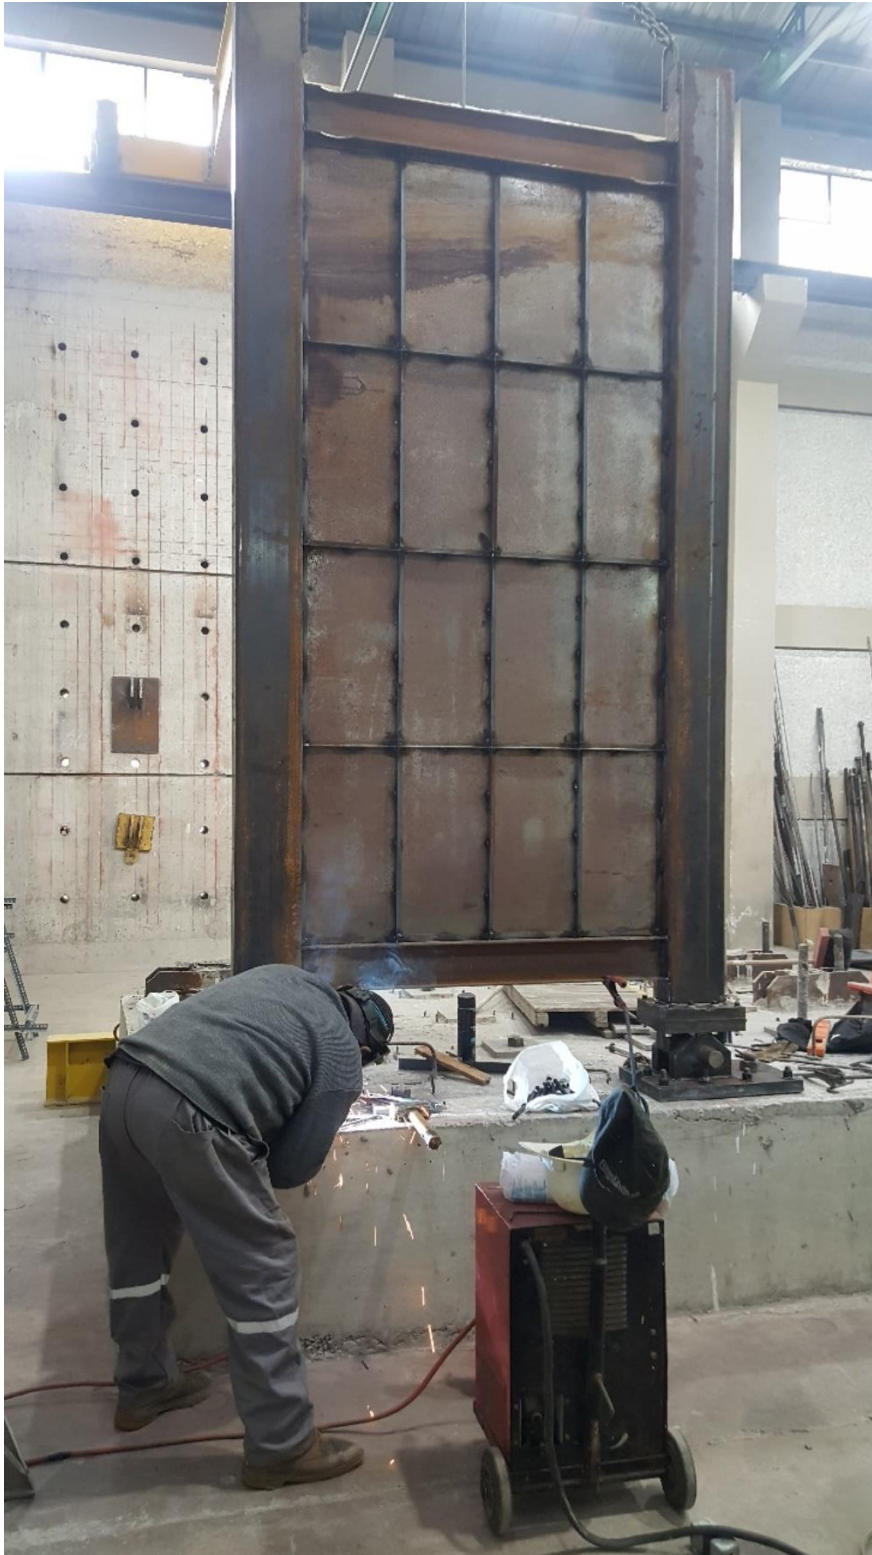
Muro con cadena para ser transportado por el puente grúa.
